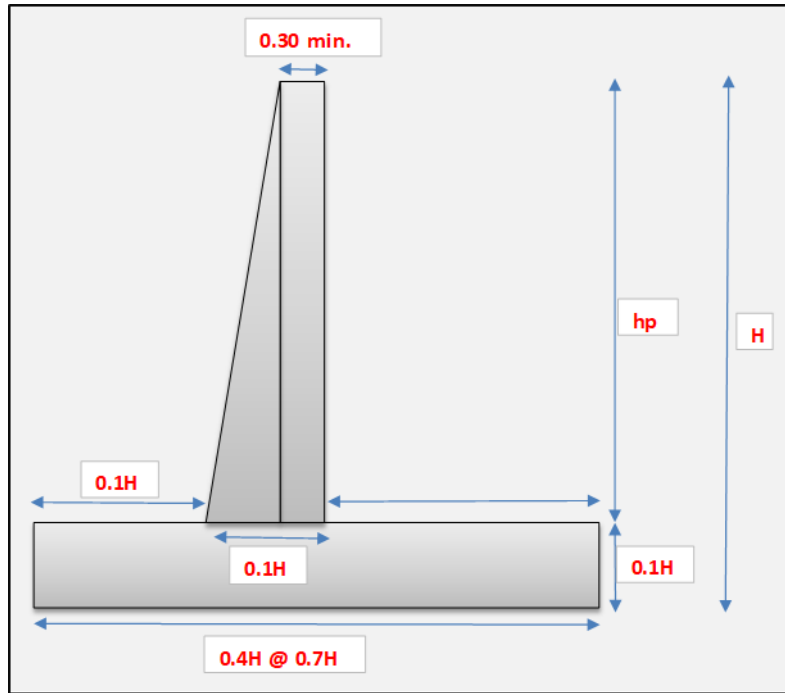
Dimensiones de un muro en voladizo sugerida por Braja M.Daz.
